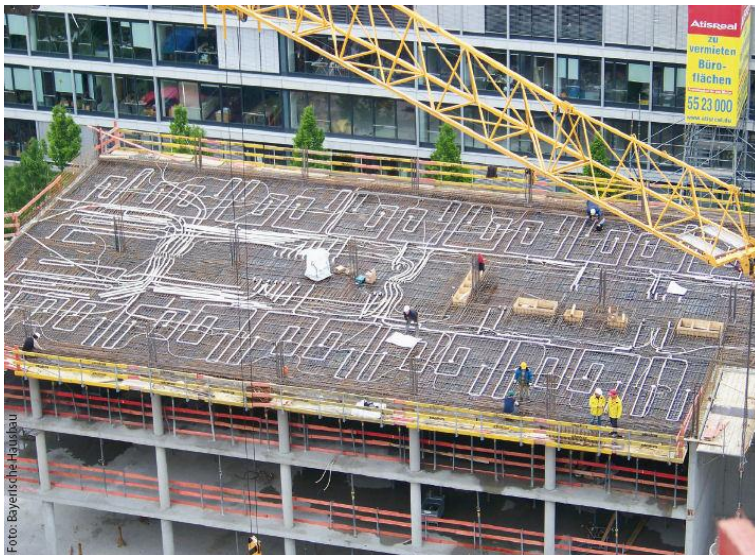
Betonkerntemperierung mit Luft – Kiefer Concretcool der Betonage (Foto: Bayerische Hausbau)
